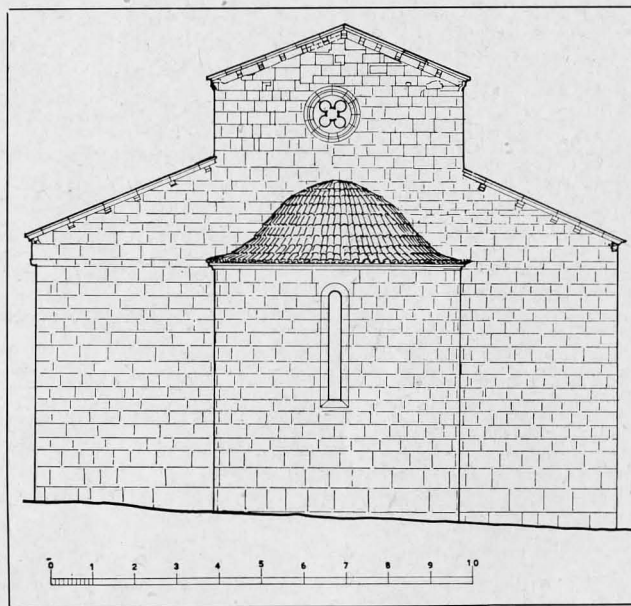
PROSPETTO POSTERIORE (SAGGIO DI RIPRISTINO)
